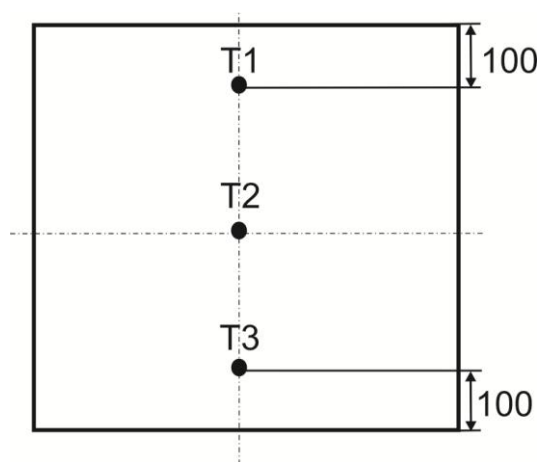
Схема размещения термодатчиков с необогреваемой поверхности металлической пластины
